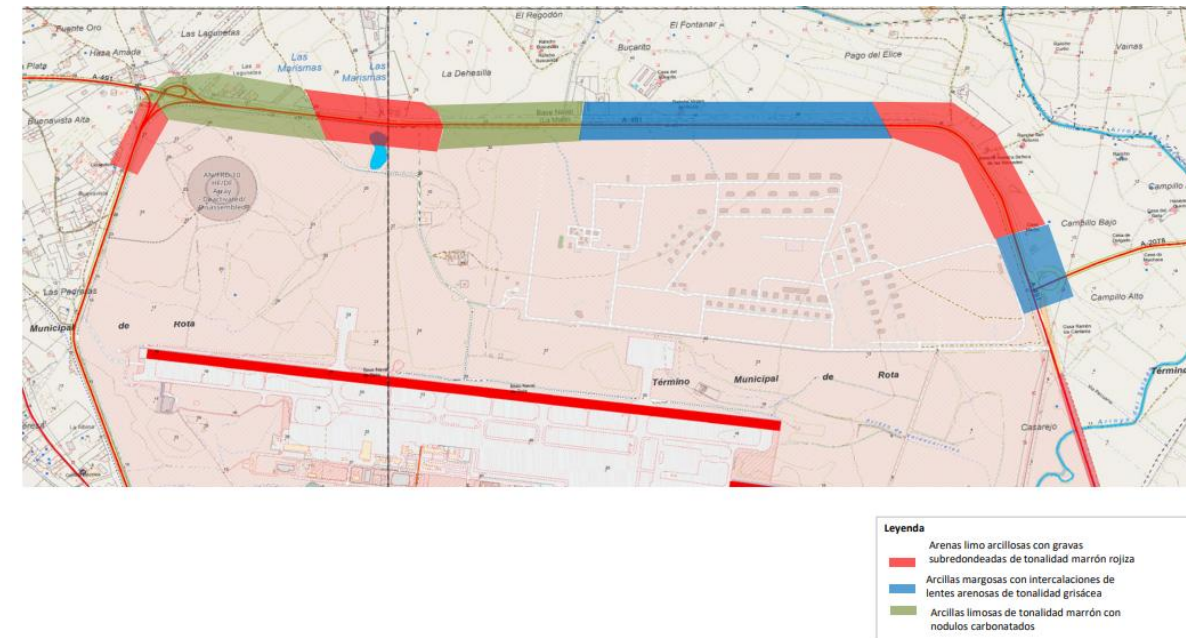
Planta de recorrido geológico. Fuente: Elaboración propia tras reconocimiento y ensayos
